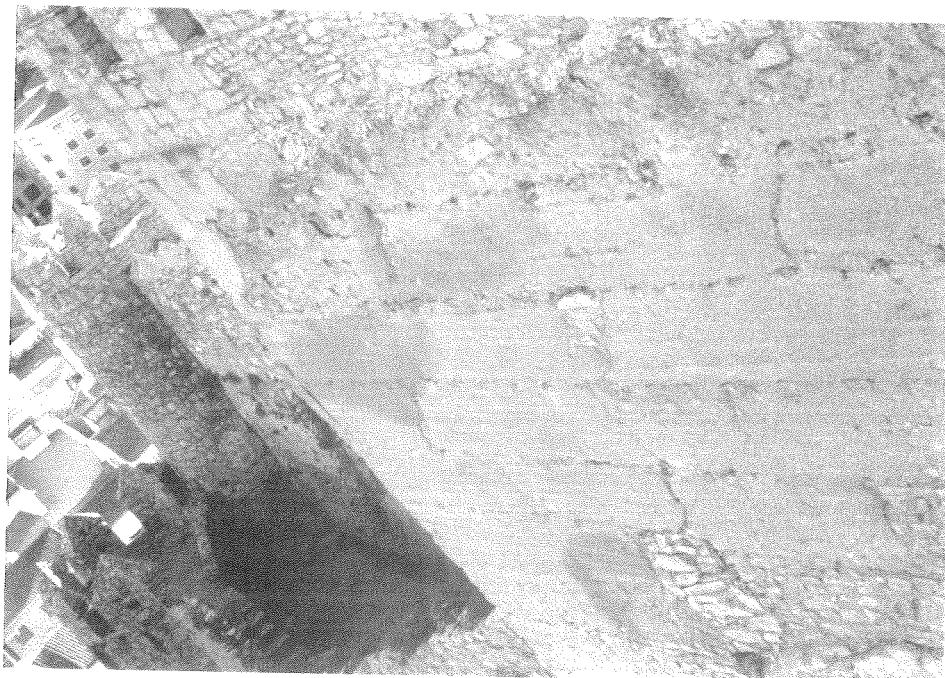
Paños de mampostería encofrada. (Foto: José Cantos Lorente).
